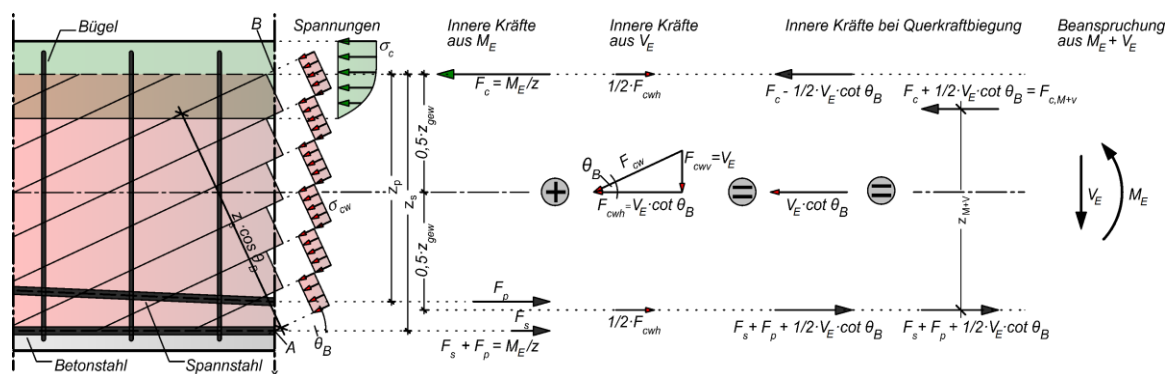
Idealisiertes Fachwerkmodell eines Spannbetonbalkens bei Querkraftbiegung im B-Bereich mit positivem einwirkenden Biegemoment
